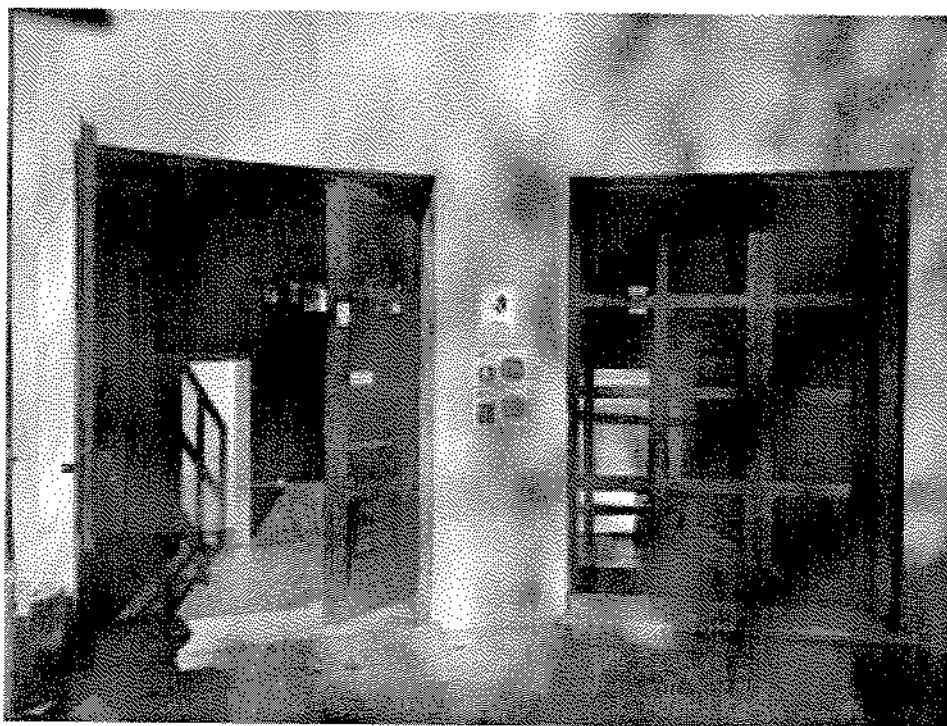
ingresso attuale della cucina posta sul lato rettilineo dell'edificio – facciata Sud
